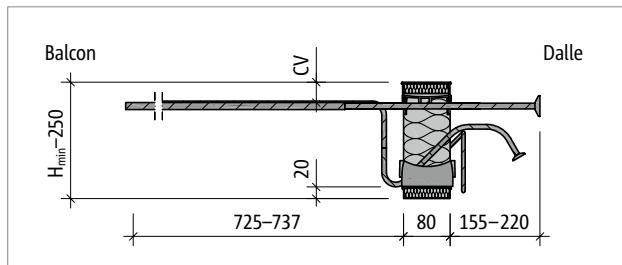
Schöck Isokorb® T type K-U-M4 : coupe du produit
